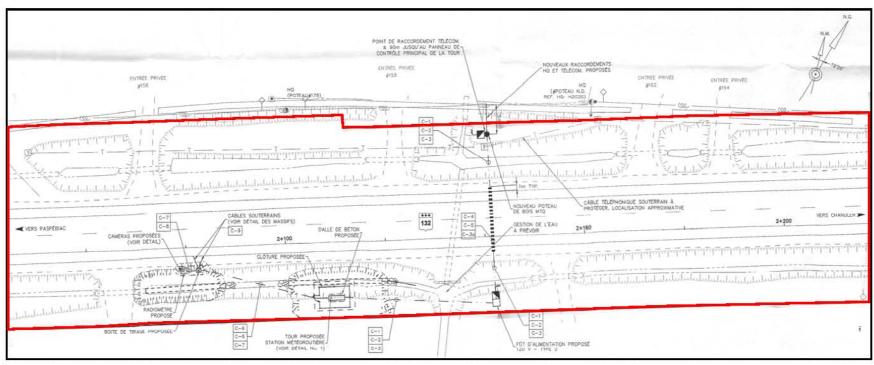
Localisation du secteur inventorié, projet nº 154-09-0297 (source : Ministère des Transports, plan d'ensemble [extrait], Détail de raccordement elect./telécom. Et agencement des équipements SMR-02, Plan EL-10-1-04055 (5/22), 24 mars 2010)
